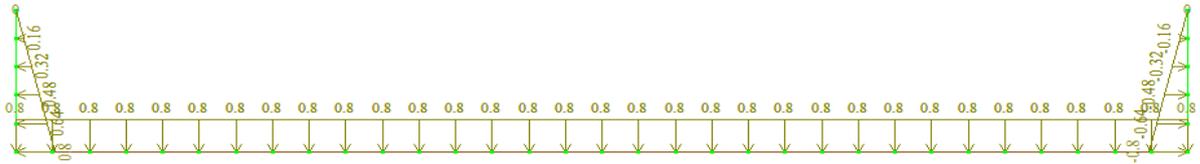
Нагрузка от гидростатического давления воды на стенки и плиту
